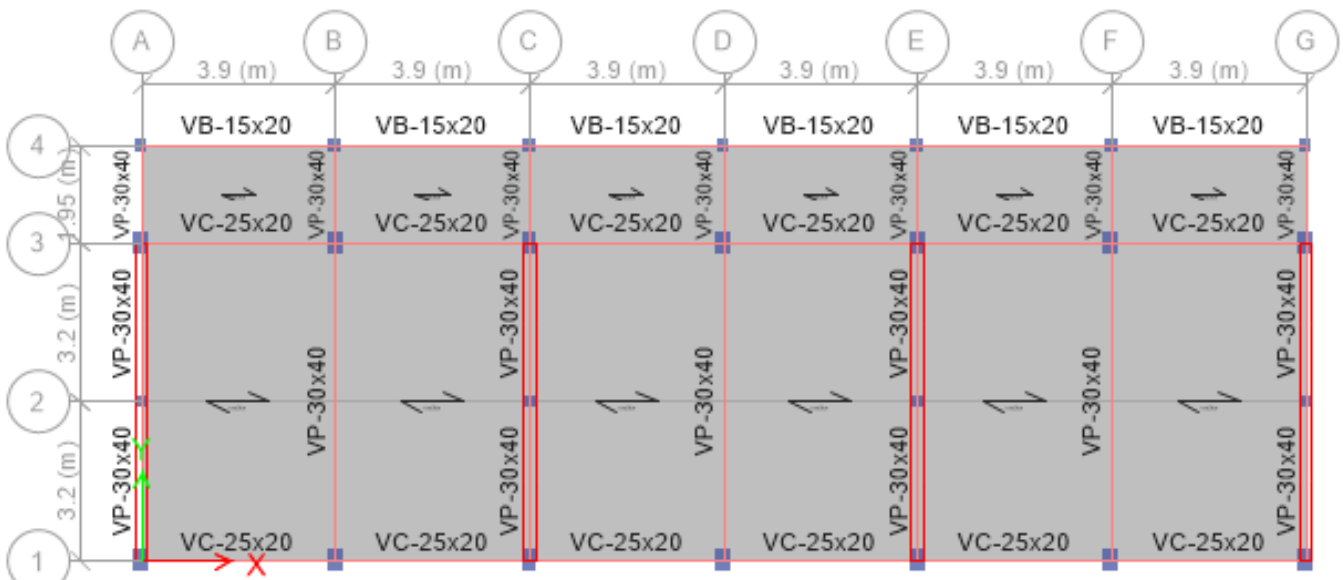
vista en planta con sus dimensiones del pabellón 3.
